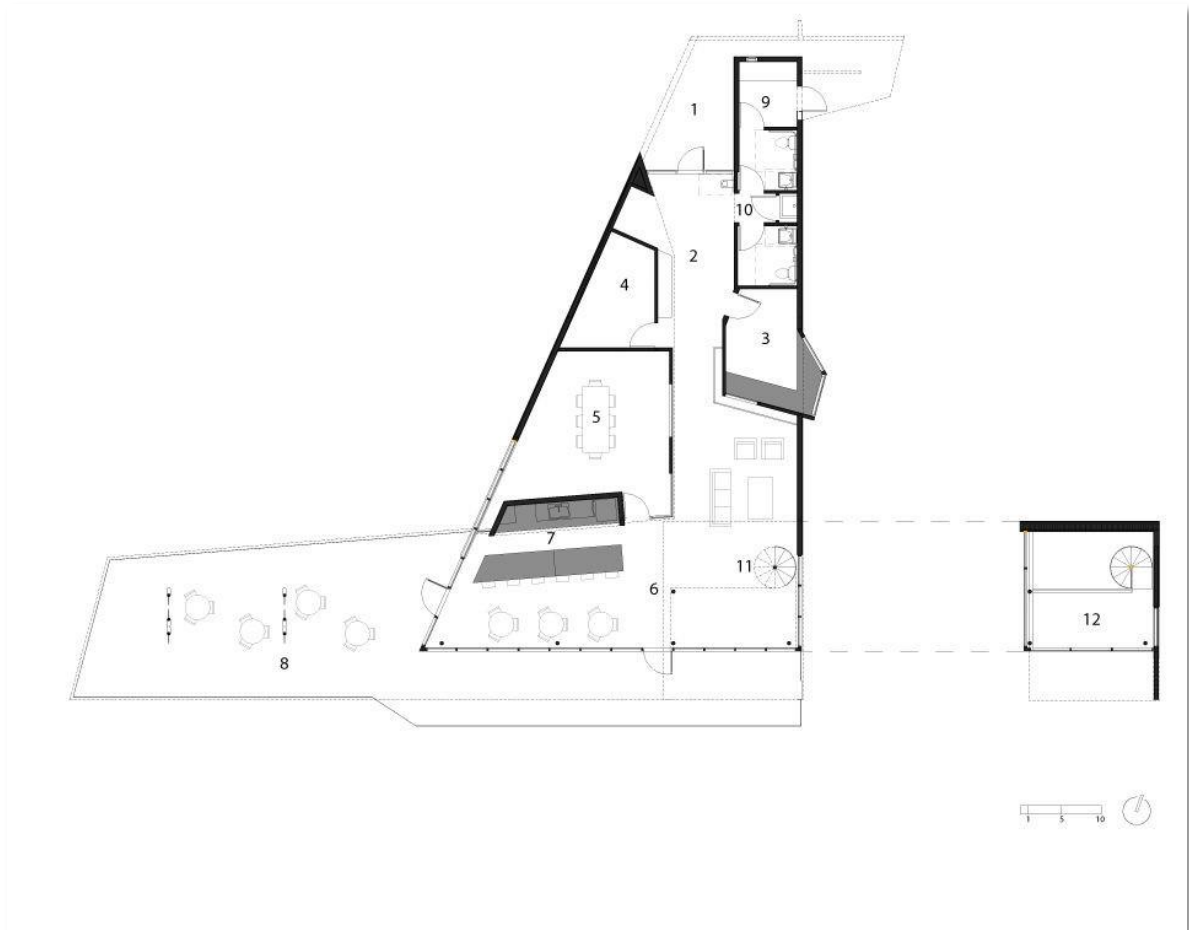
Aeropuerto de Carroll Berryville, Estados Unidos – Plano de planta. Fuente: <https://www.archdaily.com/246654/carroll-county-airport-terminal-modus-studio>
